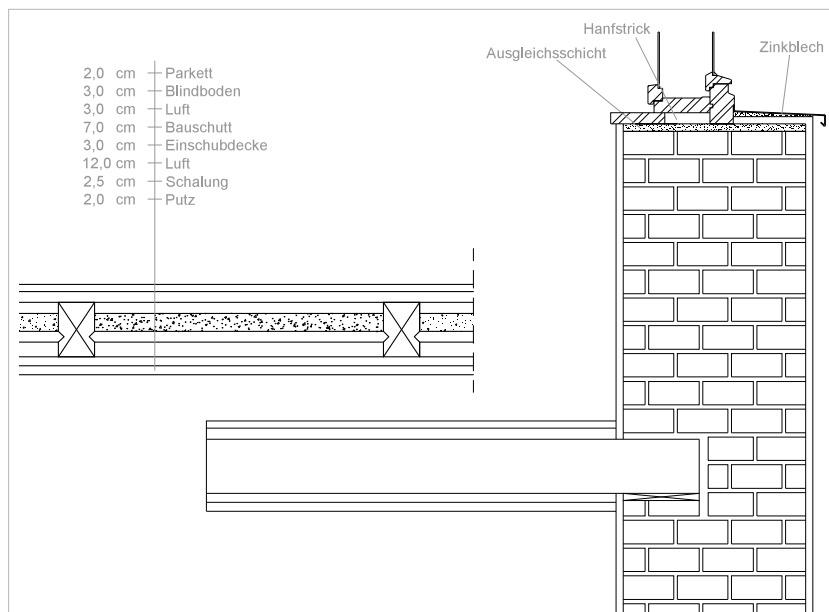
Anschlussdetail Holztramdecke an Außenwand mit Fensteranschluss
